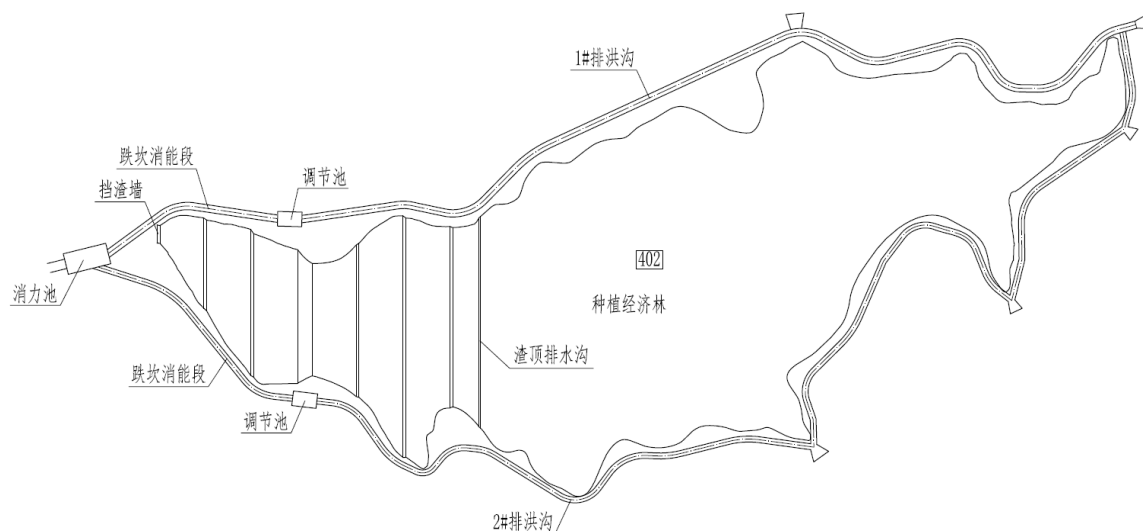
“排洪沟+消力池”方案排水布置示意图
